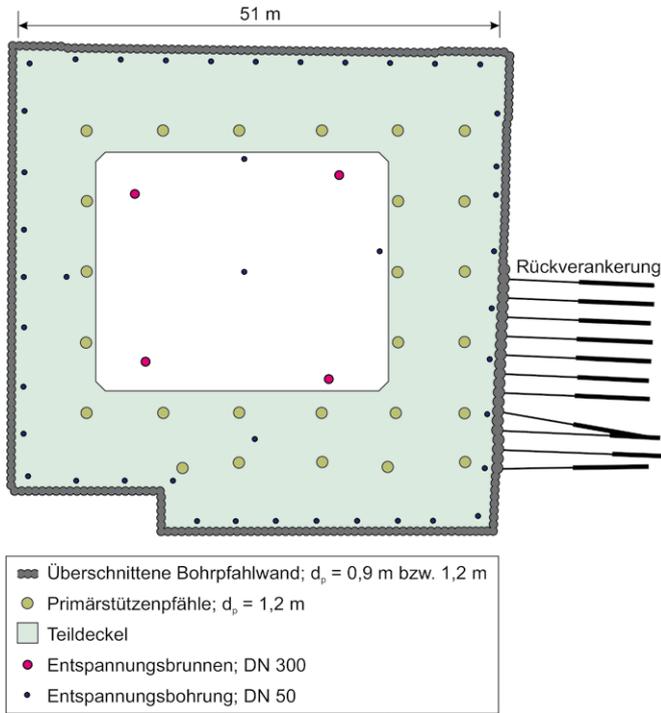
Grundrissplan Verbau, Teildeckel und Wasserhaltung
